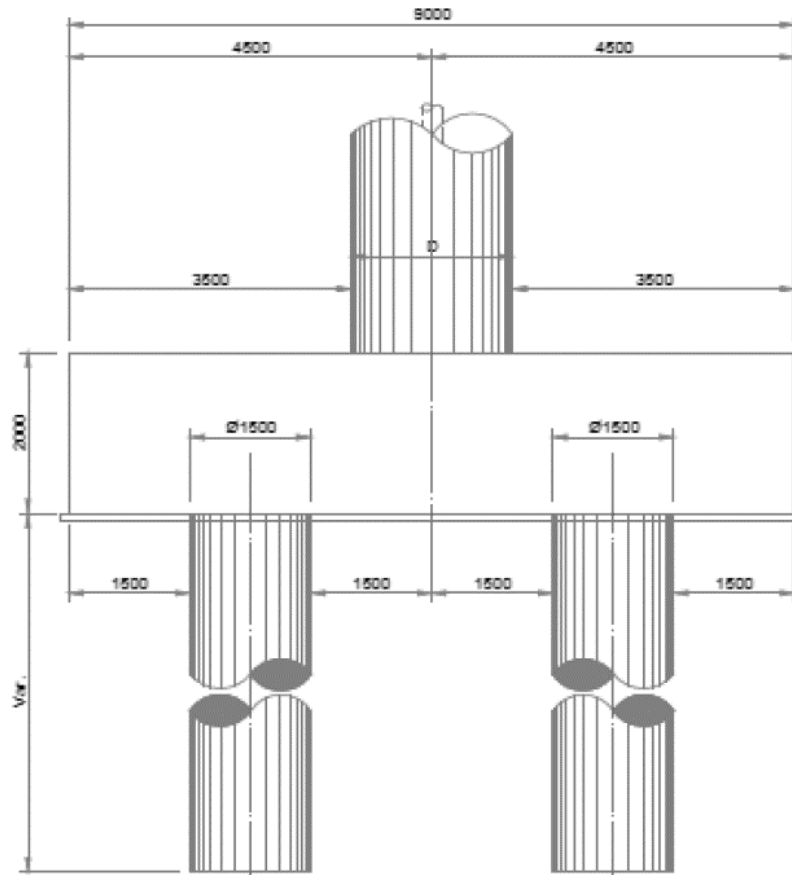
planta zapata pila simétrica PLMB, opción para línea 2
